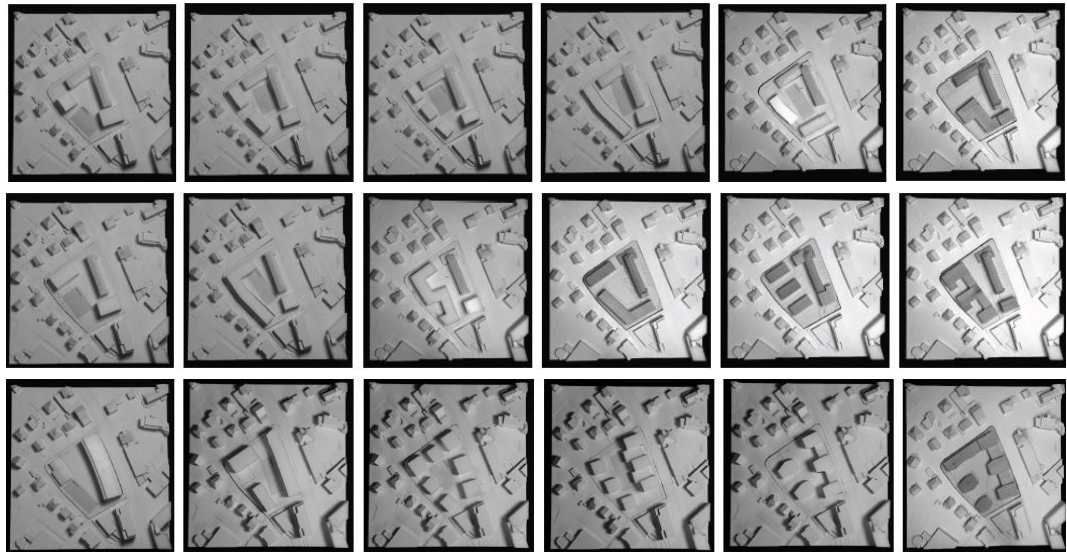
Übersicht Modelbilder Entwurfsvariantenstudium mit /ohne Erhalt Bestandesbauten
